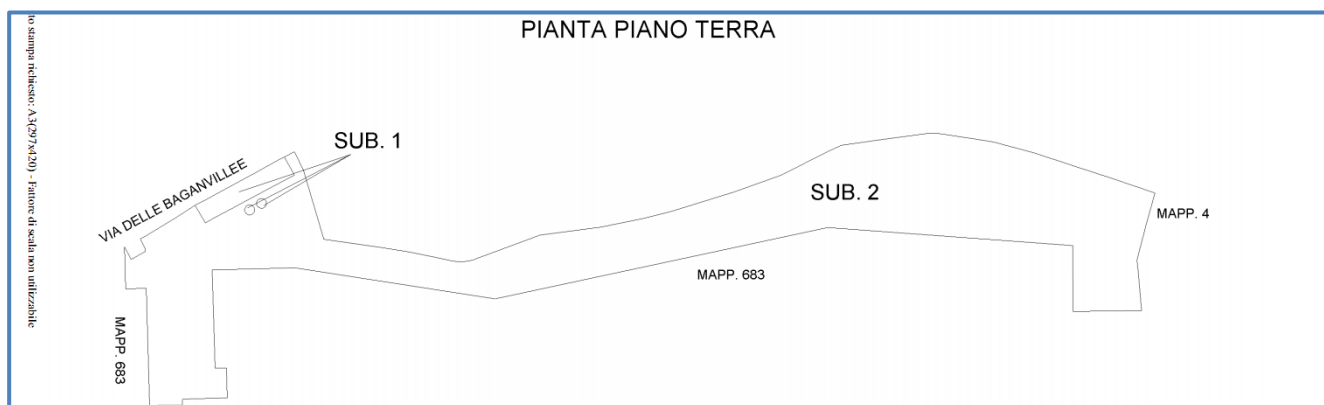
estratto dell'elaborato planimetrico prot. n°CA0019703 del 18/01/2011
